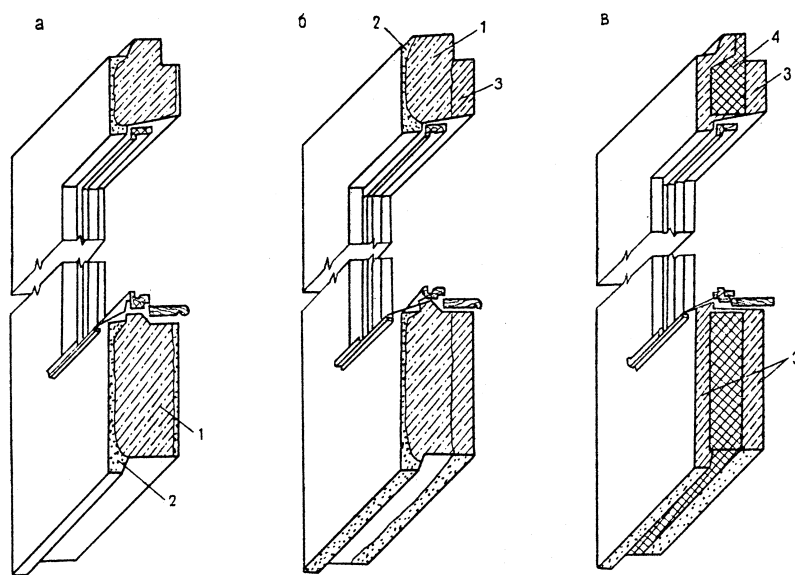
Бетонные панели наружных стен: а - однослойная; б - двухслойная; в - трехслойная; 1 - конструктивно - теплоизоляционный бетон; 2 - защитно-отделочный слой; 3 - конструктивный бетон; 4 - эффективный утеплитель
